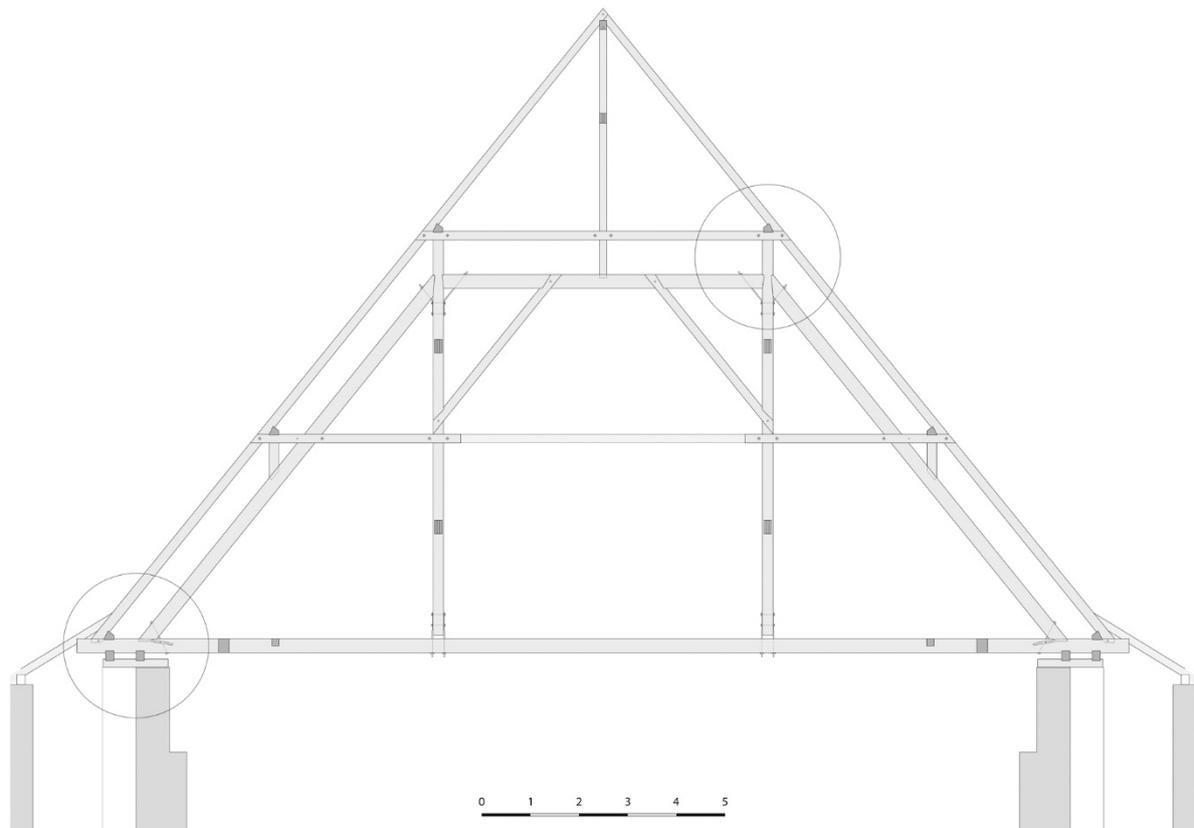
Dachwerk der Kirche Johann-Baptist in München Haidhausen (1852-1874)
